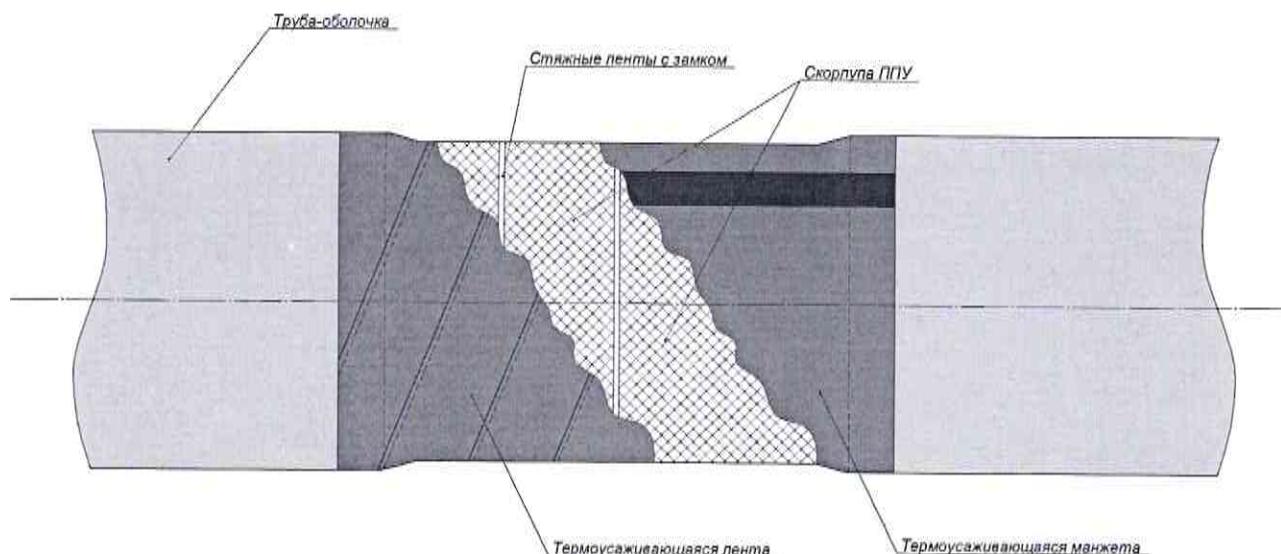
Конструкция теплогидроизоляции сварного стыка труб надземной прокладки перед установкой кожуха.
